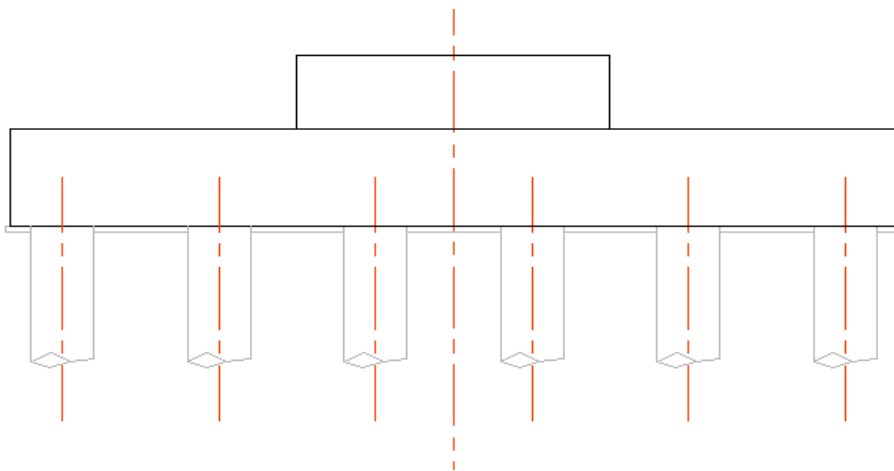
fondation (sous la pile) sur quatre files de pieux
